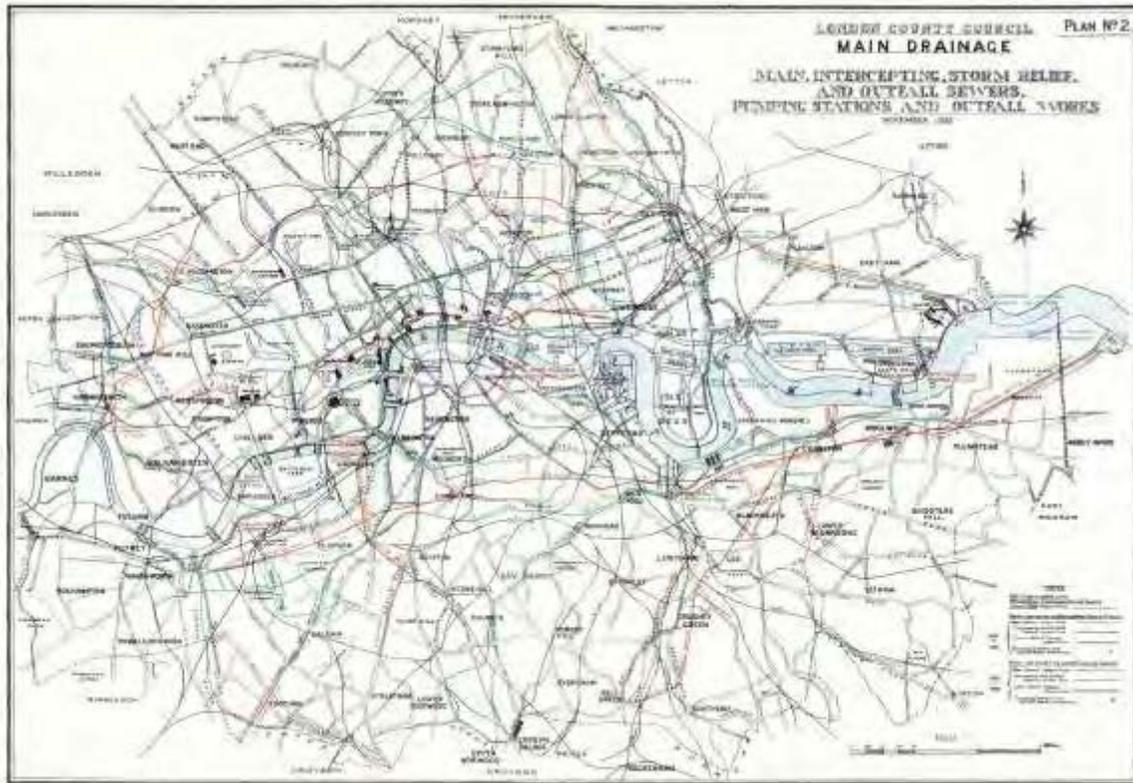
Cobertura de la red de alcantarillado de Londres hacia 1903.
